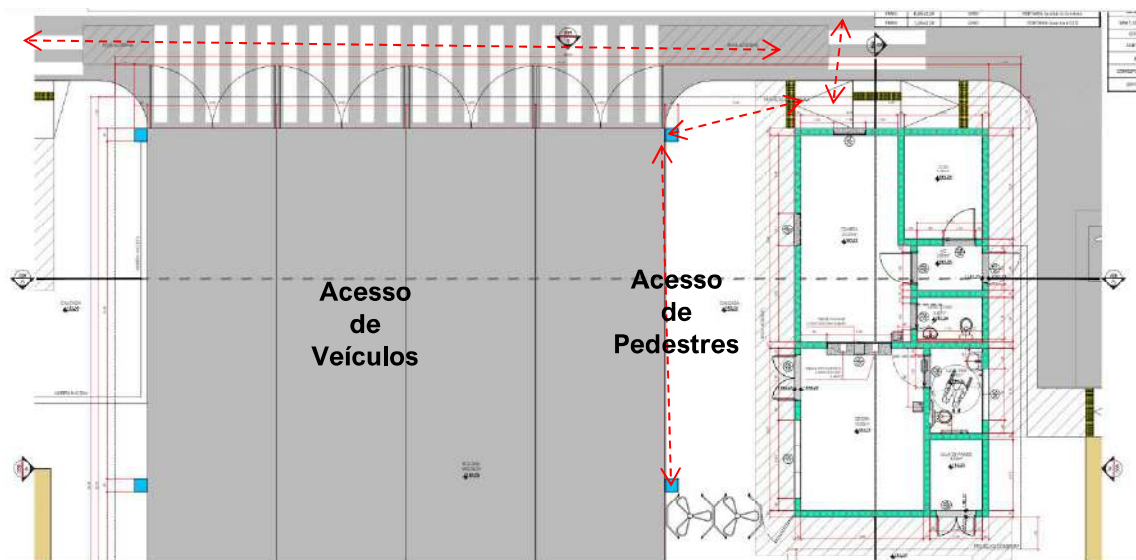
Rota acessível ao empreendimento. Fonte: Recorto do Projeto de Arquitetura – R09, em anexo.
